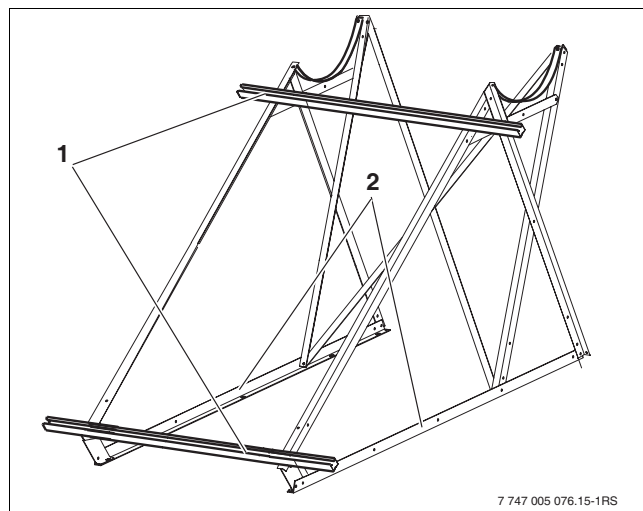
Atornillar los perfiles de cubierta plana/tejado inclinado
